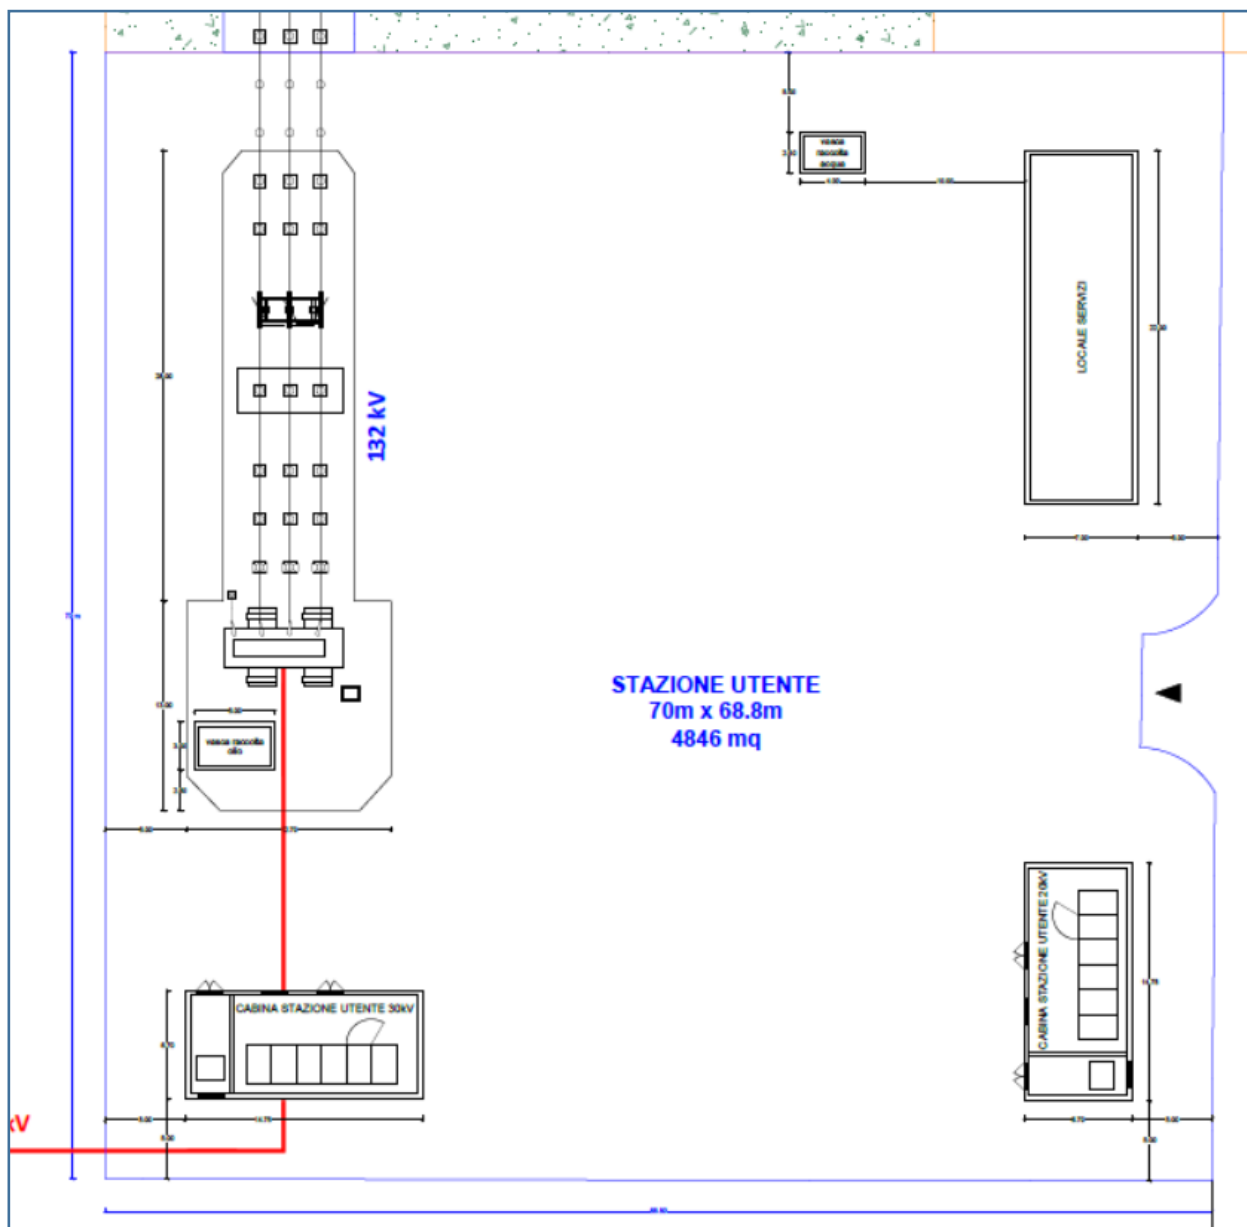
PLANIMETRIA STAZIONE UTENTE PRESSO CP MEZZOLARA
